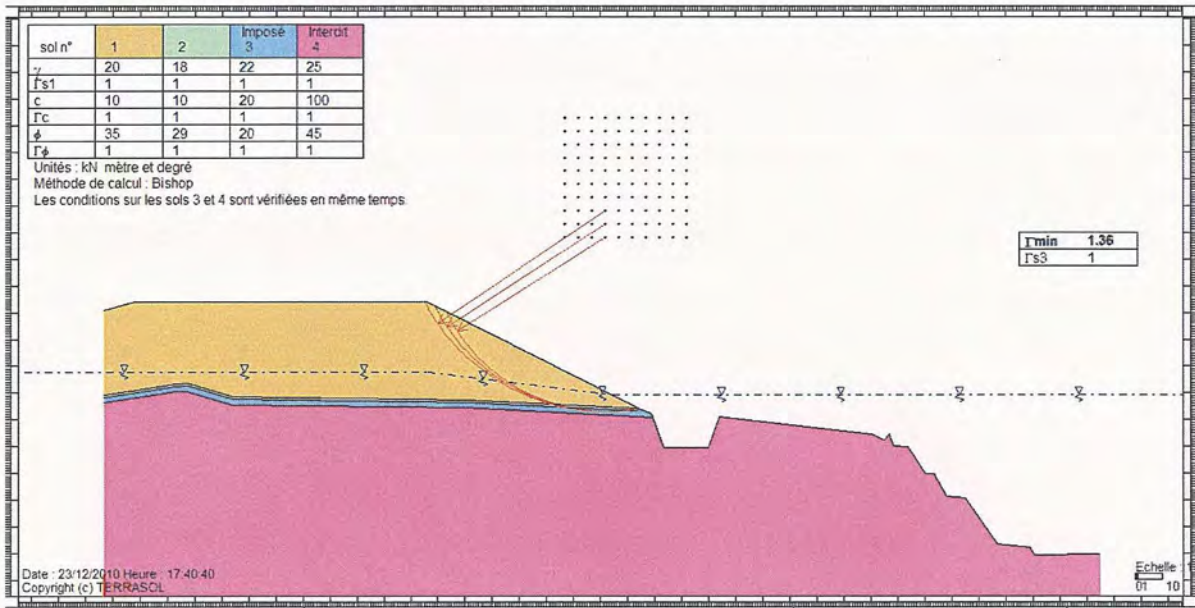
Coupe 4 : Stabilité vis-à-vis d'un glissement profond avec remontée accidentelle du niveau de la nappe
